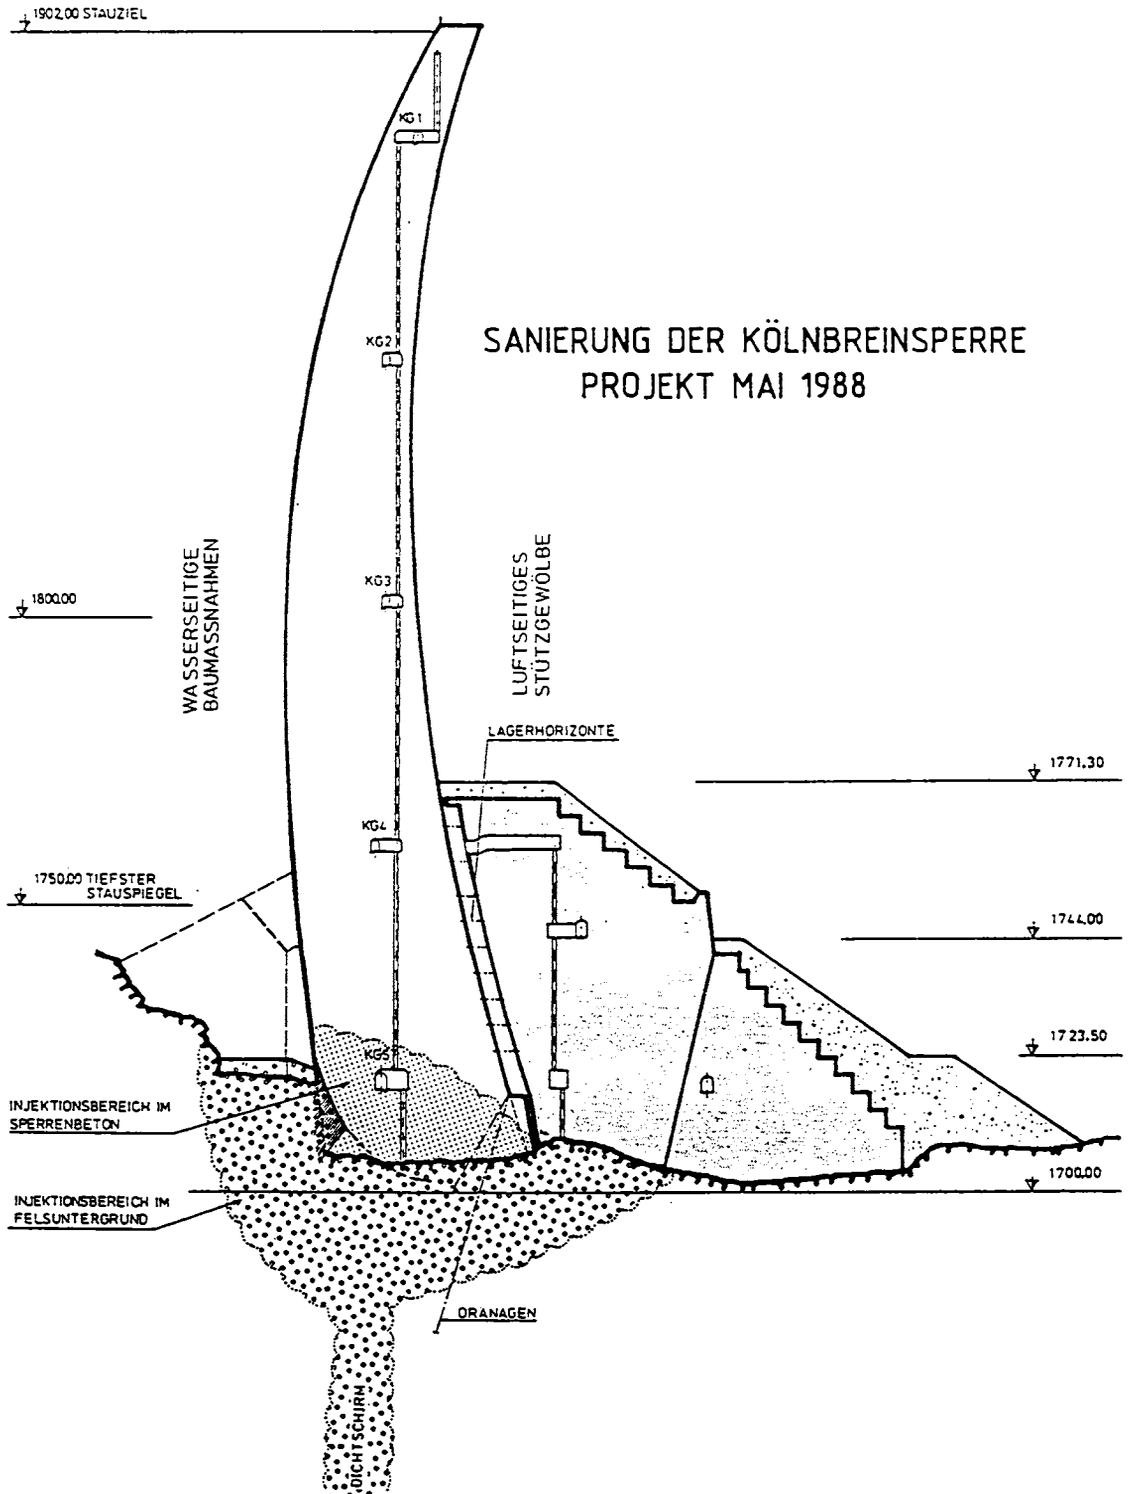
Sanierung der Kölnbreinsperre, Projekt Mai 1988
